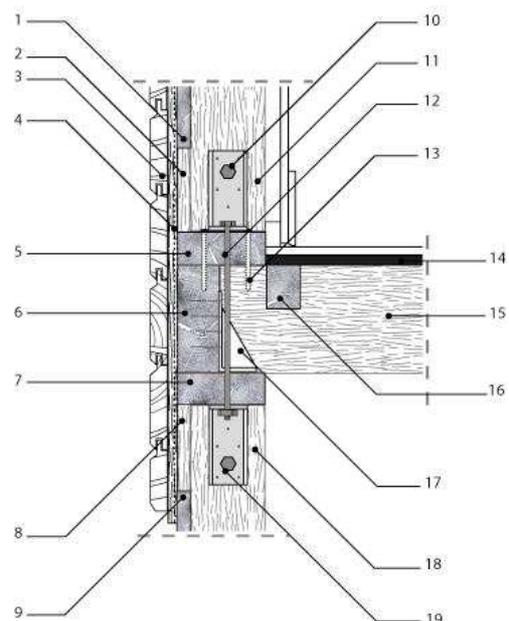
Coupe de principe : ancrage de la traverse basse du niveau 1 sur le plancher haut du RdC. Panneaux de contreventement murs PST de façade
